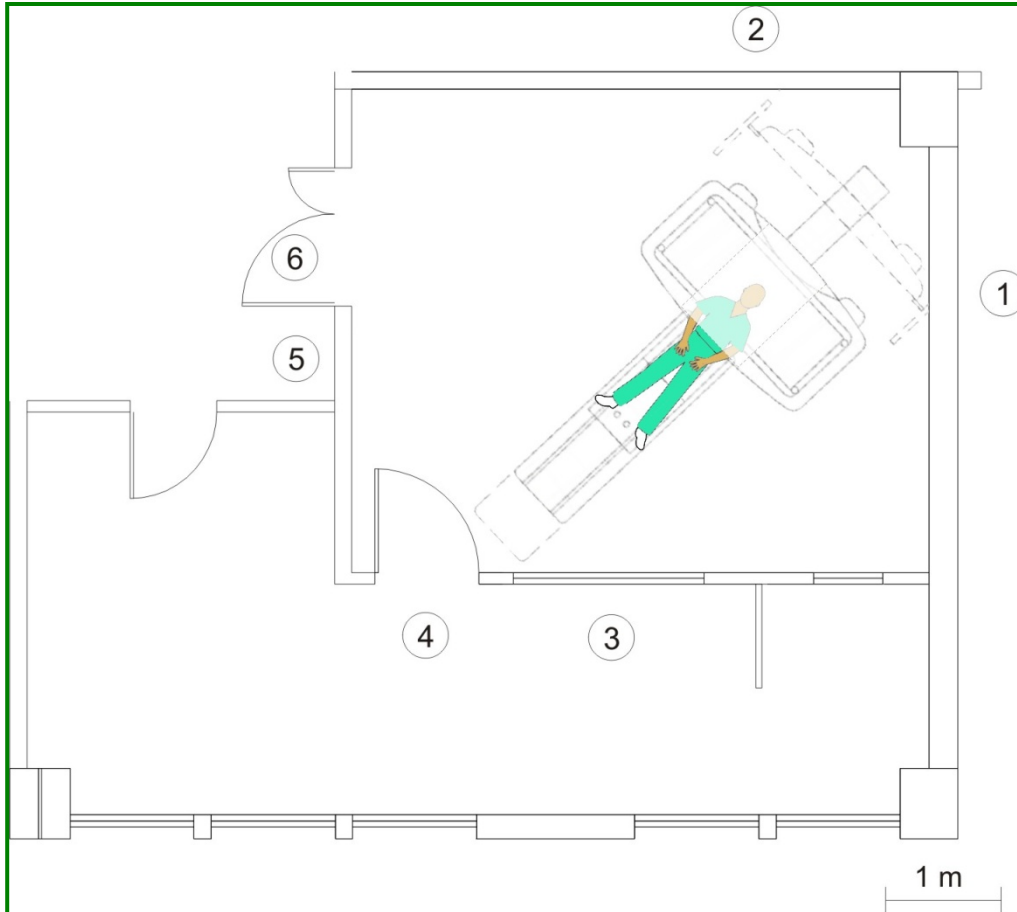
Planta arquitectónica da sala de Tomografia Computorizada.
